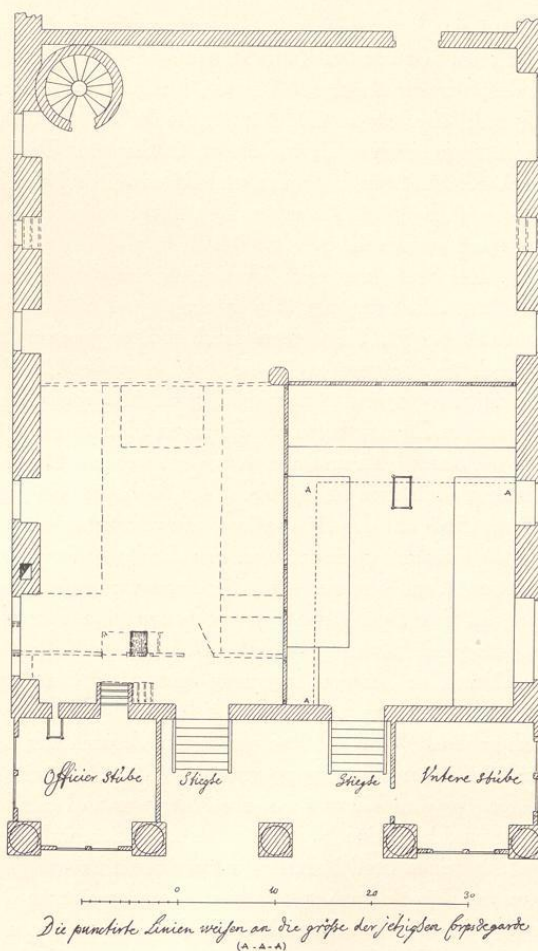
Grundriß des Erdgeschosses des Rathauses, 1708
